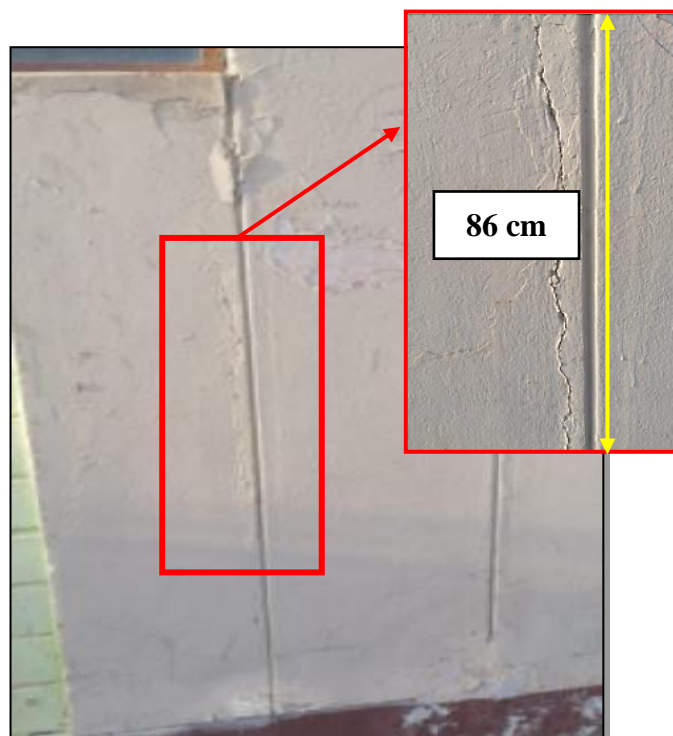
Fisuramiento de las columnas – Primer Nivel
